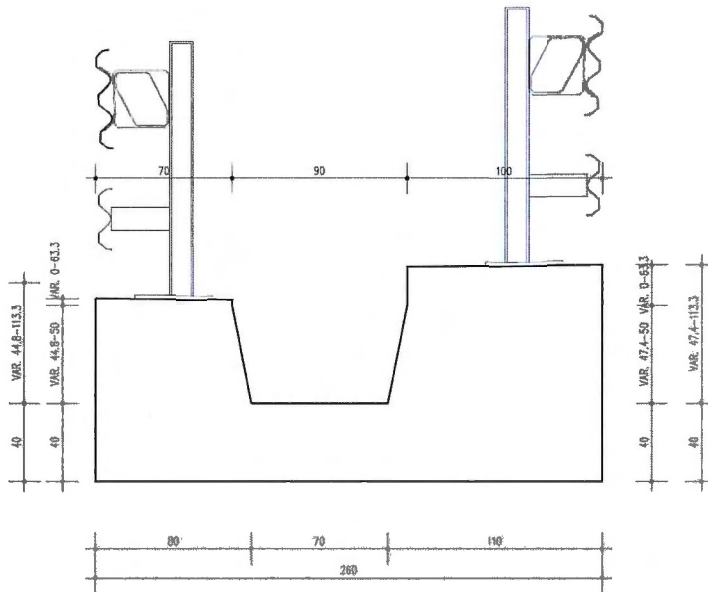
Sezione Tipo E (Barriera Doppia) – Tratto 5
